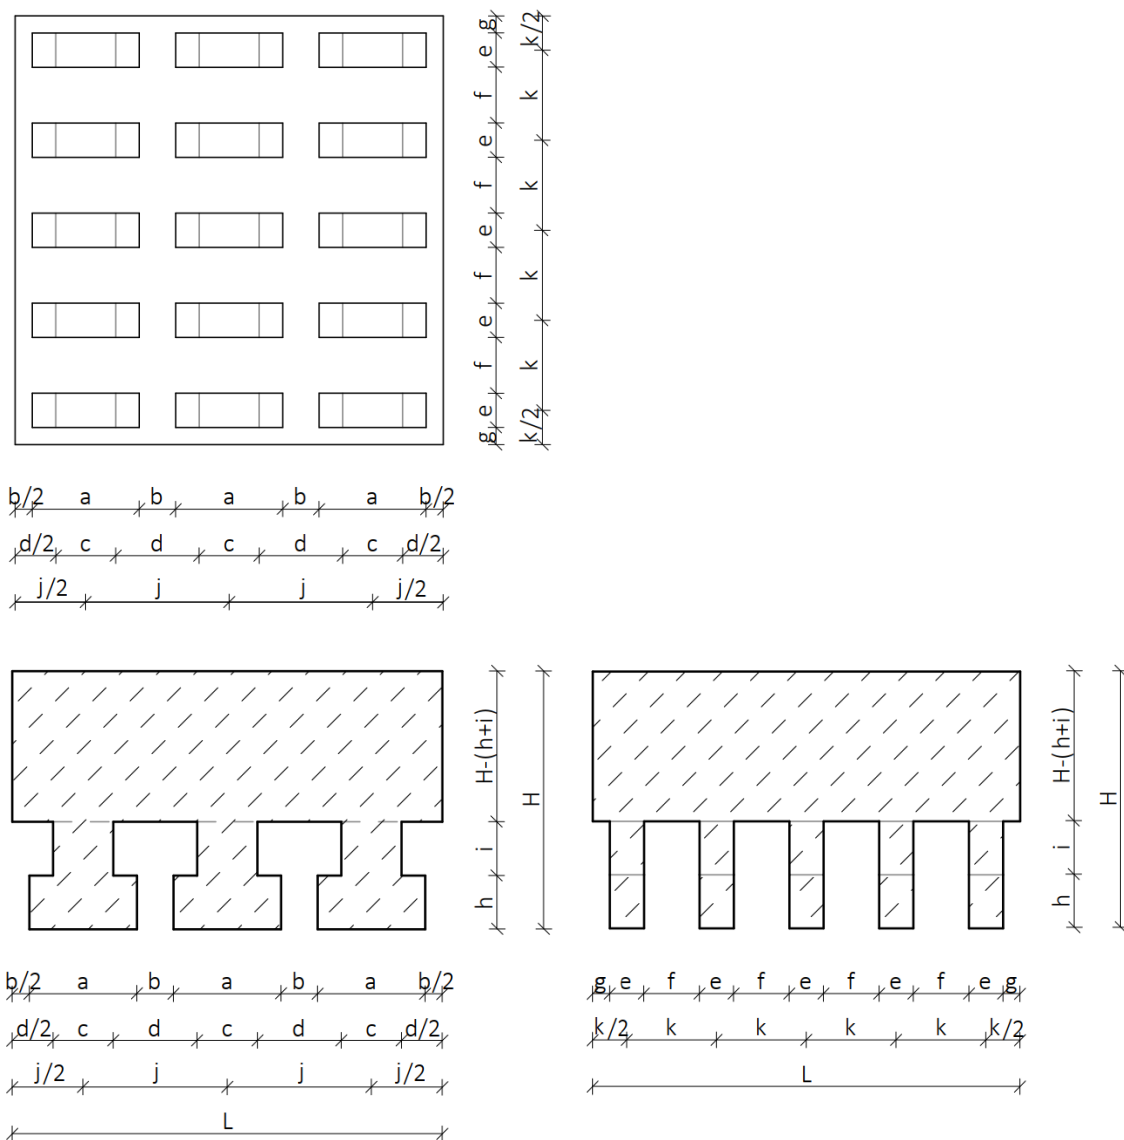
Betonkörper in Untersicht (o) und Längsschnitt (u, li) wie auch Querschnitt (u, re)
